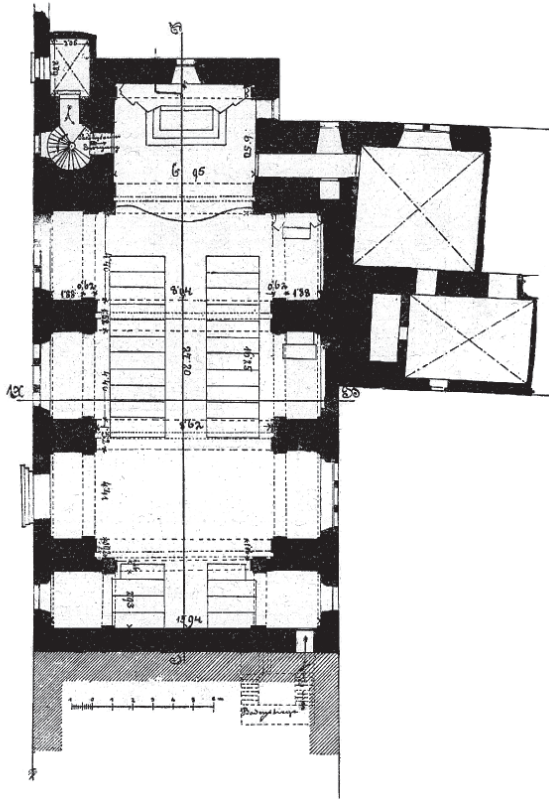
Telč/Teltsch, Jesuitenkirche, Grundriß
